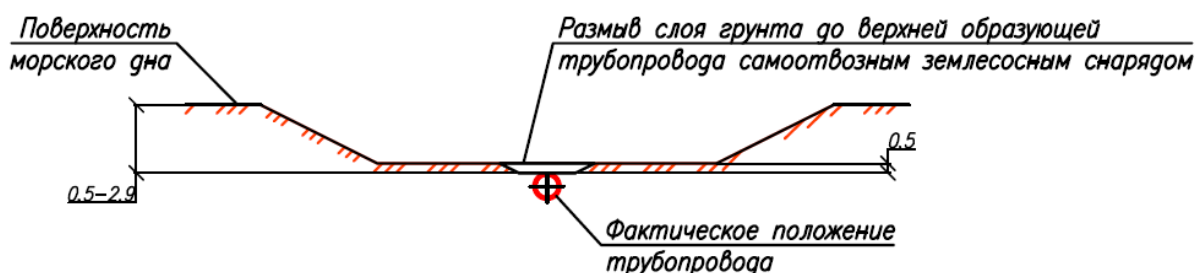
Размыв слоя грунта самоотвозным землесосным снарядом
